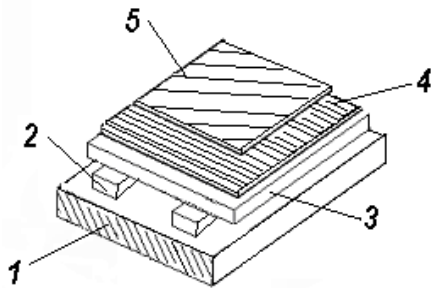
Наливна безшовна підлога: 1 – бетонна підготовка; 2 – звукоізоляційні прокладки; 3 – керамзитобетонна плита; 4 – вирівнювальний шар – цементна стяжка; 5 – опоряджувальний (різнокольоровий) шар
